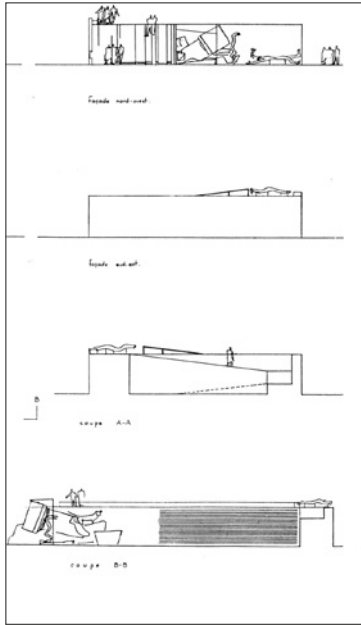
Plan, élévation, coupe du Monument au Martyr (fragment)
